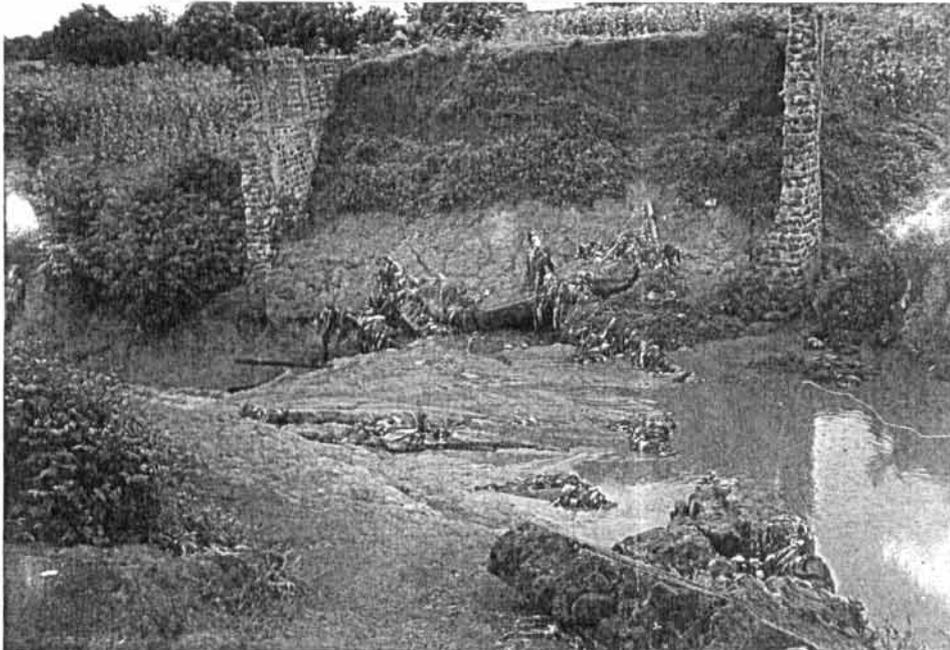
Restes du pont effondré sur le Wé en 1986. Il est à constater la très faible profondeur des fondations. (Surtout à gauche)
